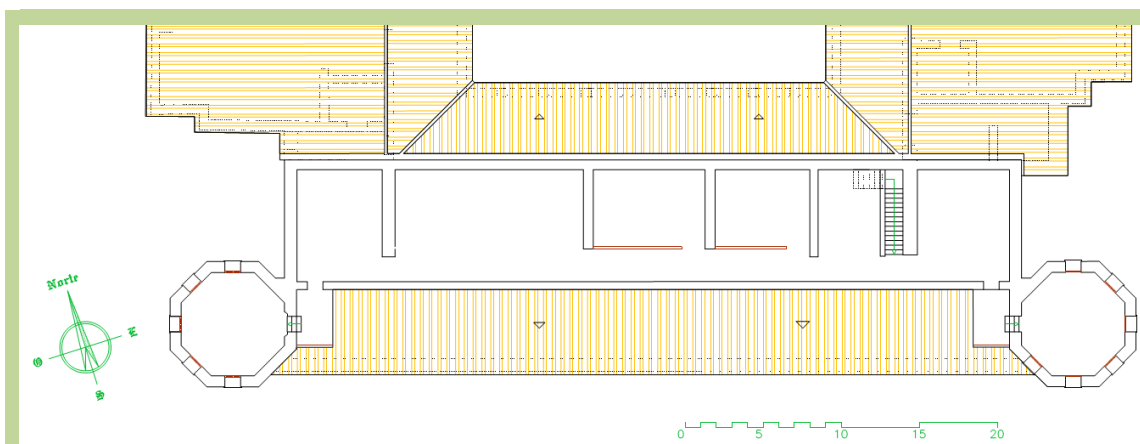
Planta primera del ala sur de La Olmeda (reconstrucción virtual -I-). CGS.
